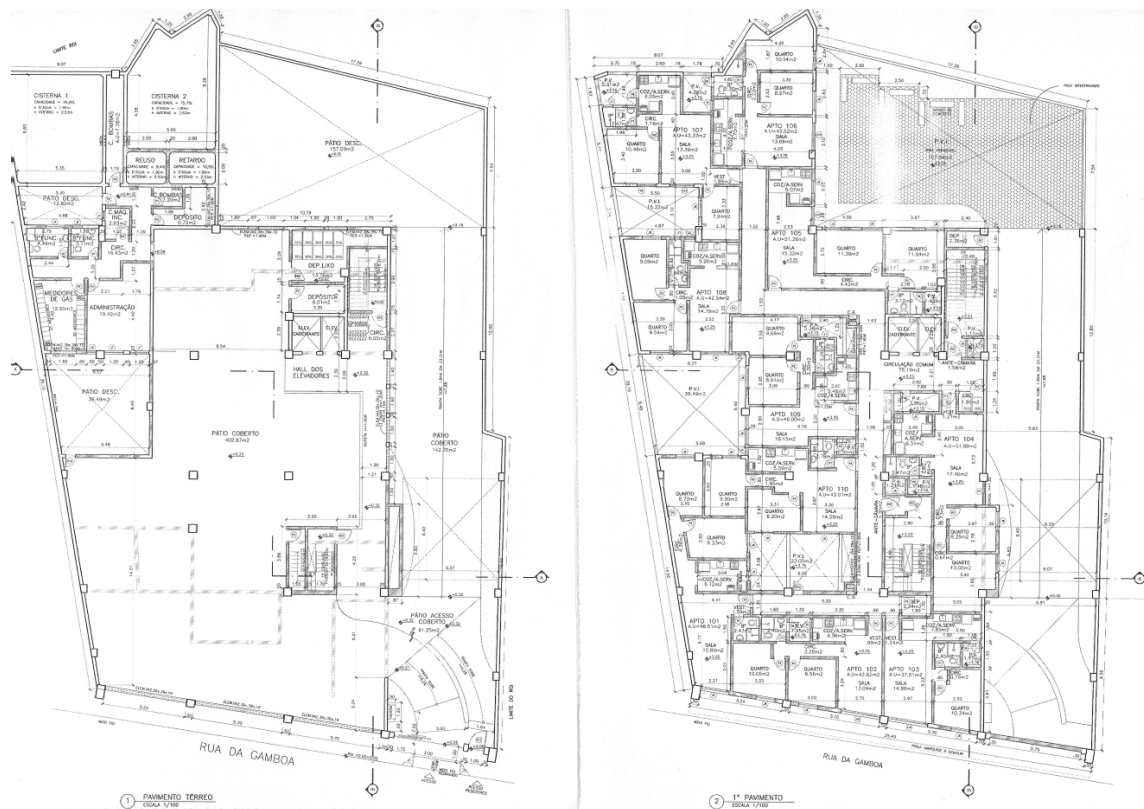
Planta baixa do térreo e 1º pavimento do empreendimento Gamboa 111.
